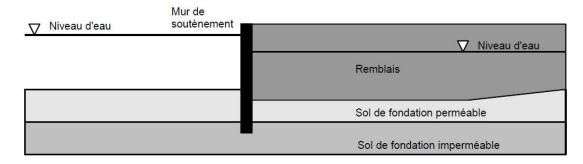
coupe-type d'un mur de soutènement (adapté de [Ciria, Medde, Usace, 2013])
